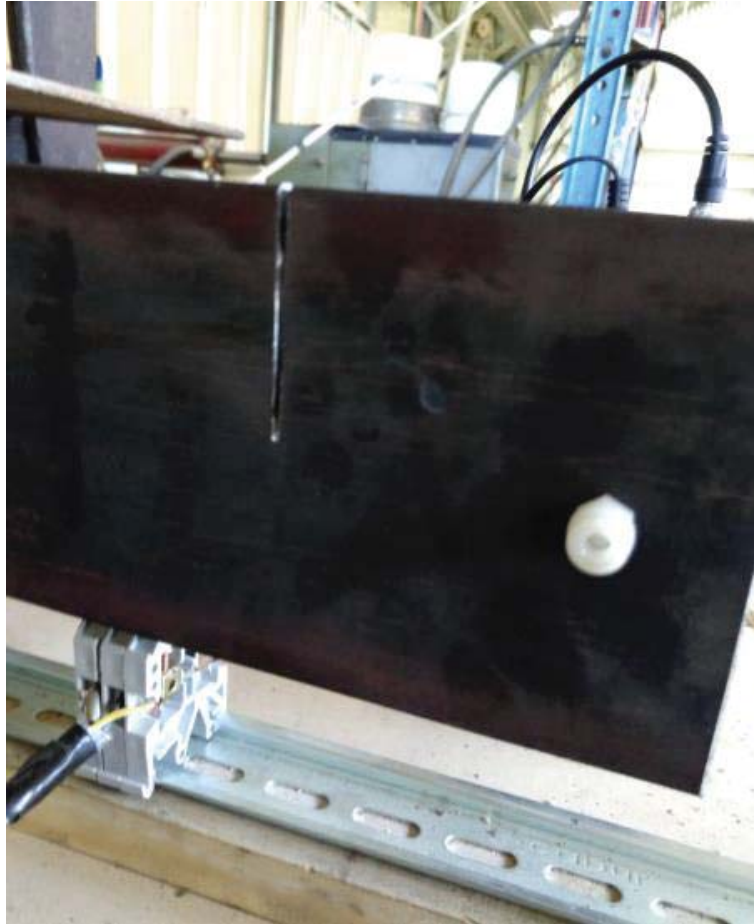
Viga con grieta, extremo libre.
